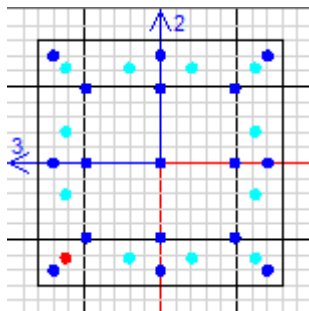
Modelo de fibras da secção transversal de um pilar da estrutura
